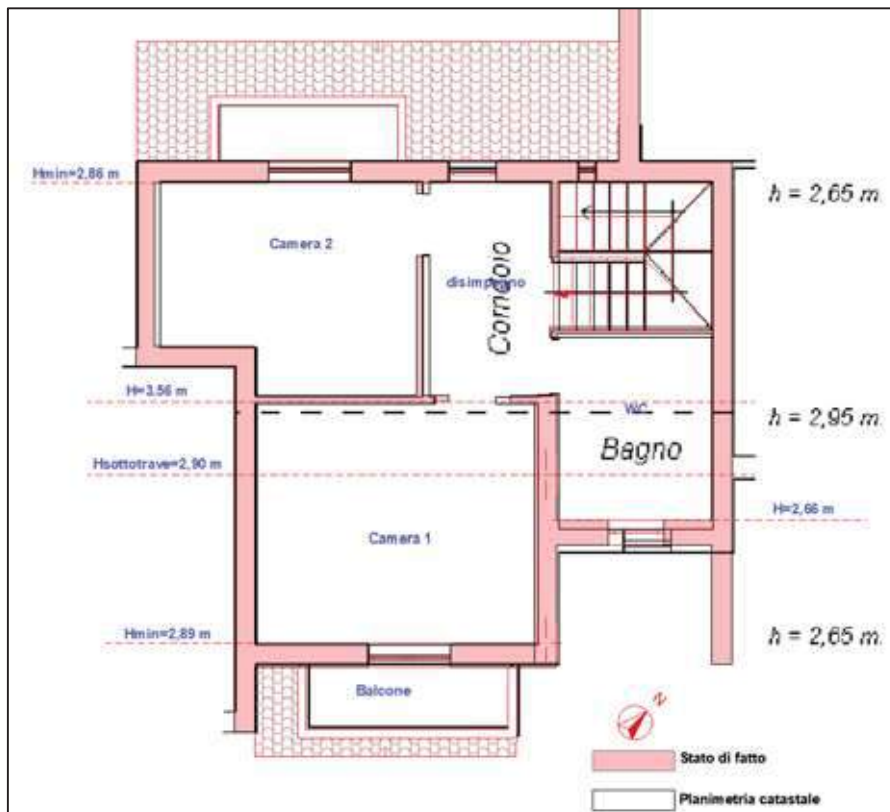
Sovrapposizione visura planimetrica catastale dell'appartamento pignorato (foglio 2 particella 875 sub 2) e rilievo effettuato in fase di sopralluogo – Piano seminterrato.
